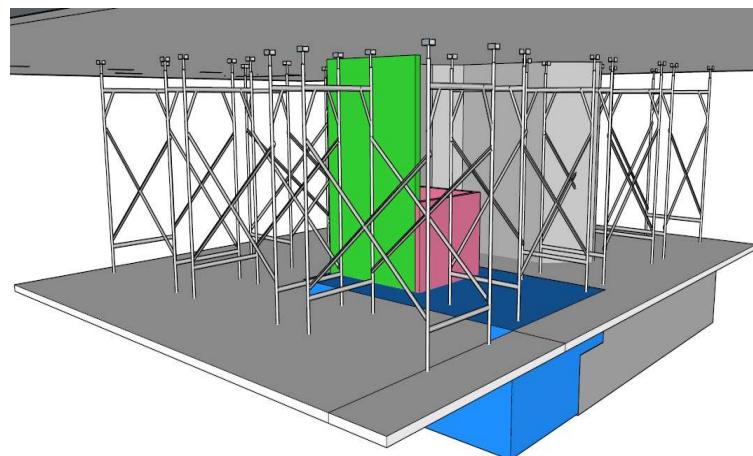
Desenho esquemático do reforço da sapata (azul), do novo pilar (verde - PN304) e do poço do elevador (rosa).
